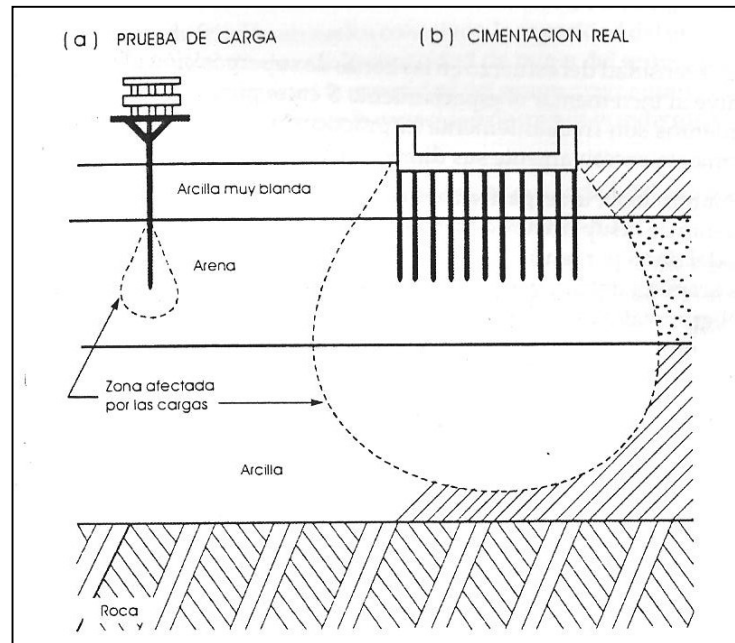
Vista de distribución de cargas en un grupo de pilotes
